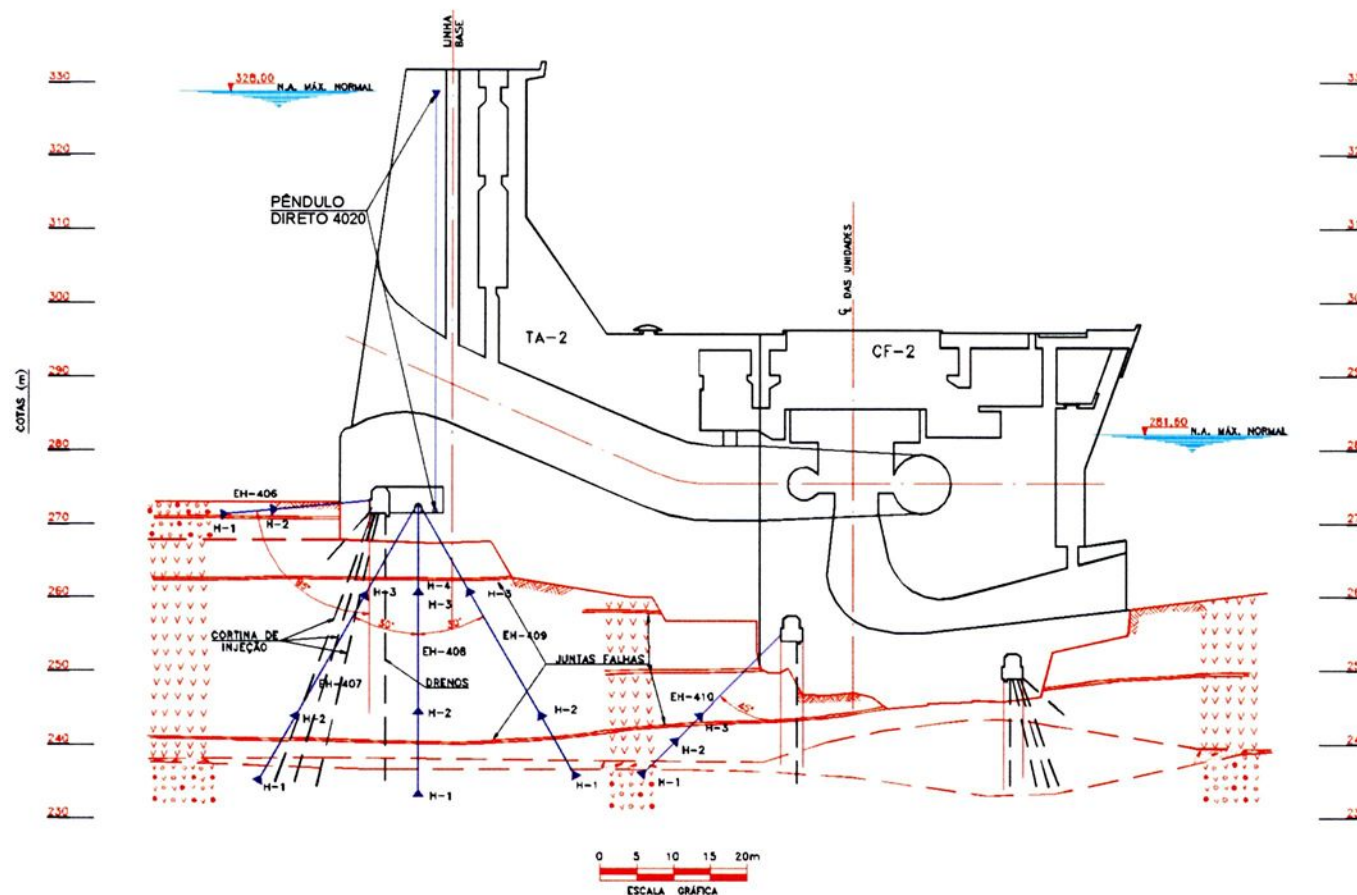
Corte transversal de estrutura de concreto da UHE Três Irmãos,
